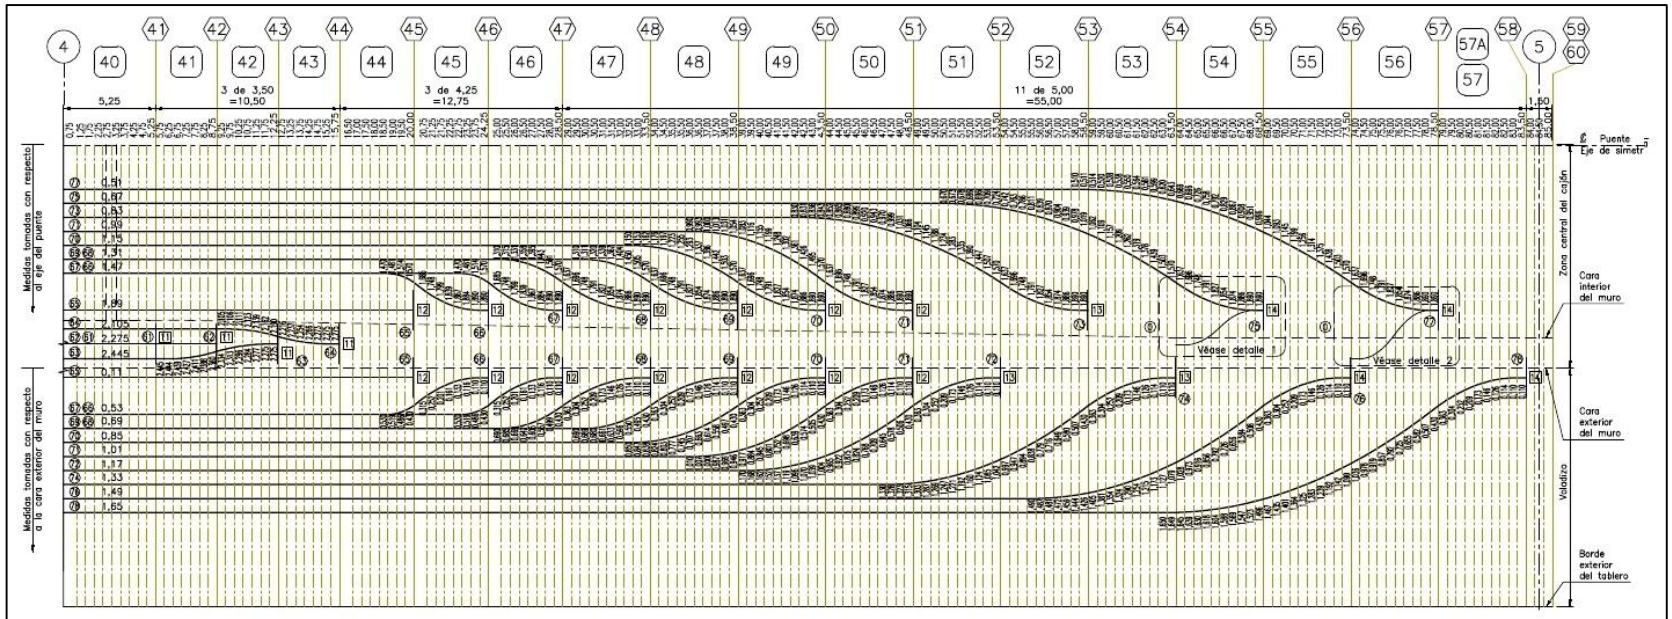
Trayectoria de los cables en Semiplanta Superior de los Voladizos 5 y 6.
